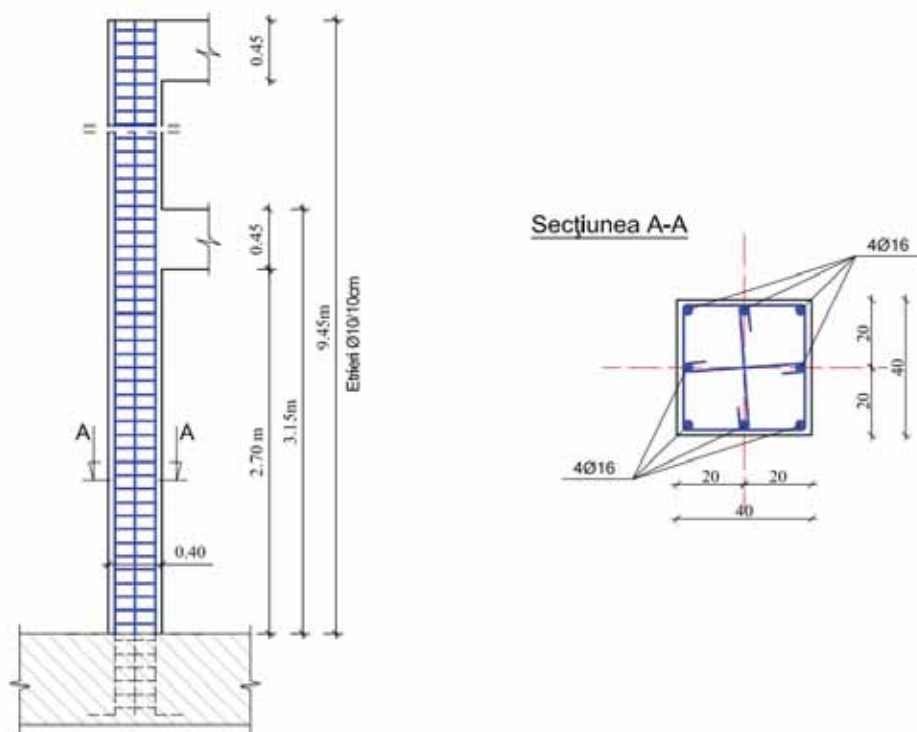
Structură P+2E: plan armare stâlp b.a.
